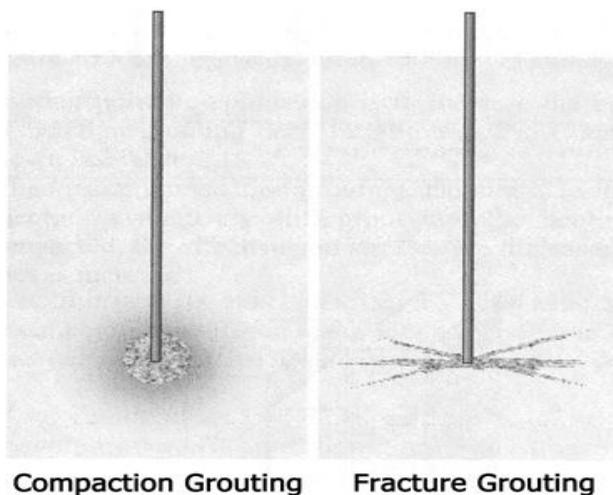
Напорная иньекция без разрыва (Compaction Grouting) и с разрывом (Fracture Grouting)
